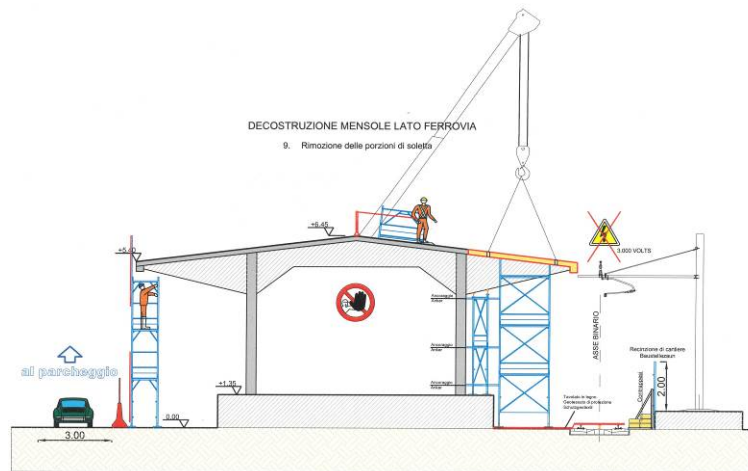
Sezione Demolizione Edificio A9 – Rimozione porzione di soletta
